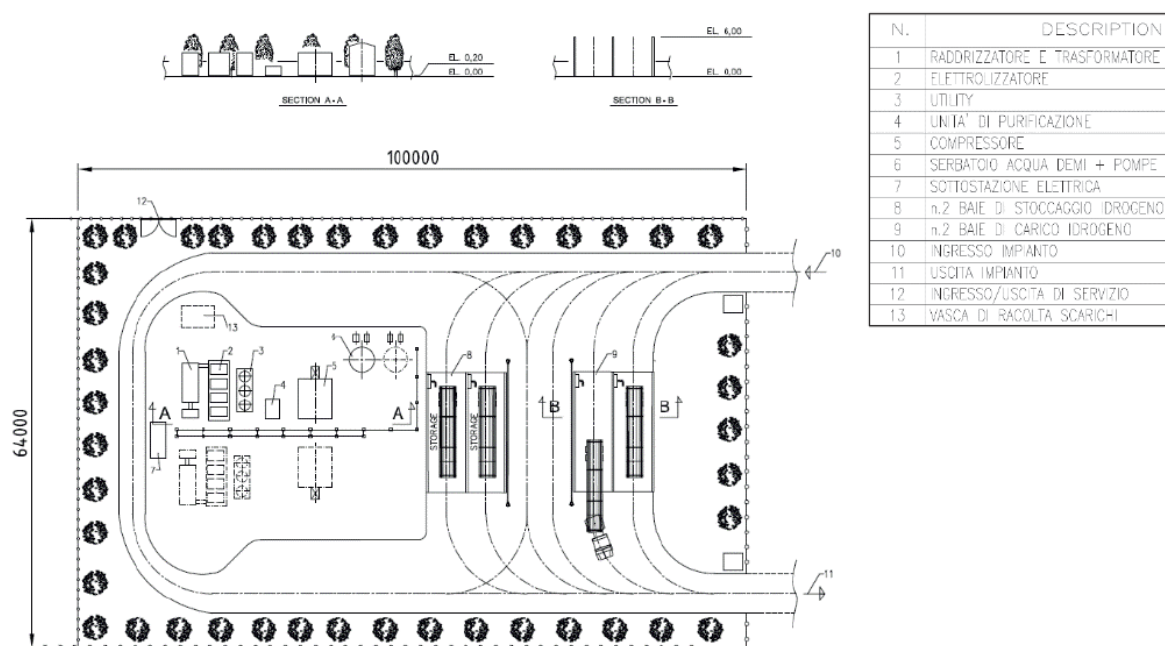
Planimetria preliminare dell'Impianto di Idrogeno Verde.
